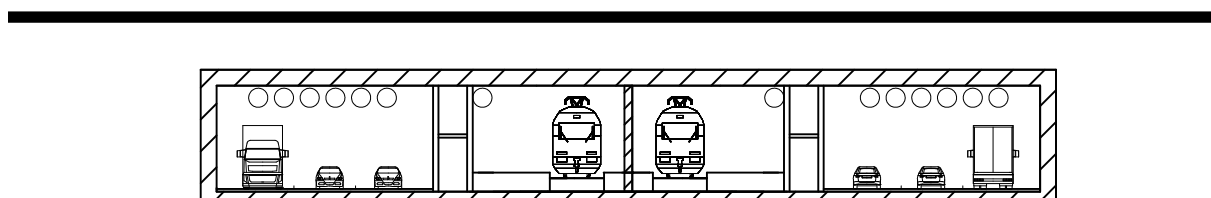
Tunnel mixte ferroviaire routier en tranchée couverte.
